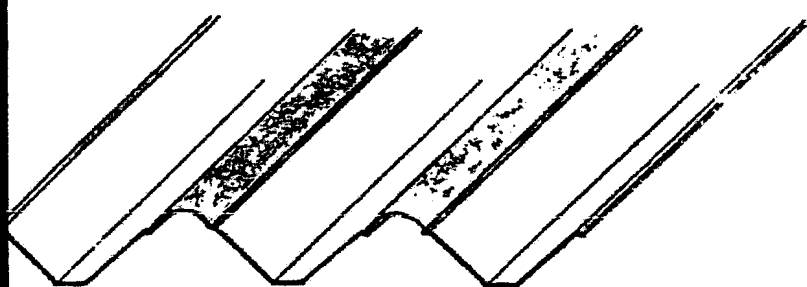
Disposición de los tragaluz con las estructuras plegadas en "U".
